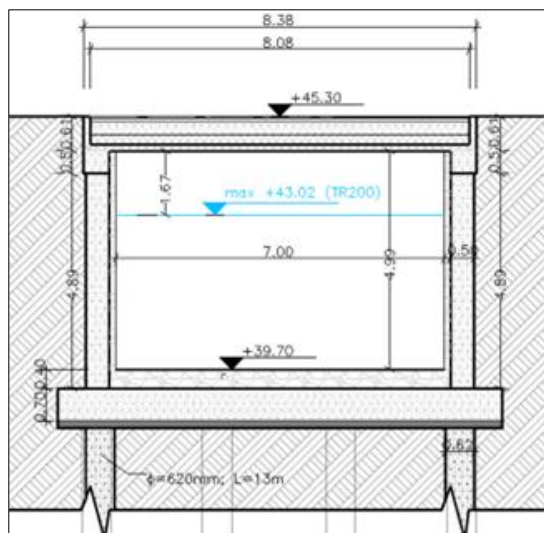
Sezione trasversale del ponte stradale di Via Vigo sul T. Onte
